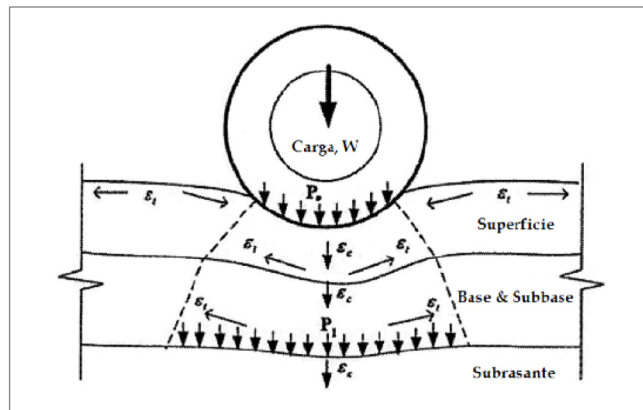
Deformaciones en pavimentos flexibles y distribución de cargas (Du et al., 2008)
